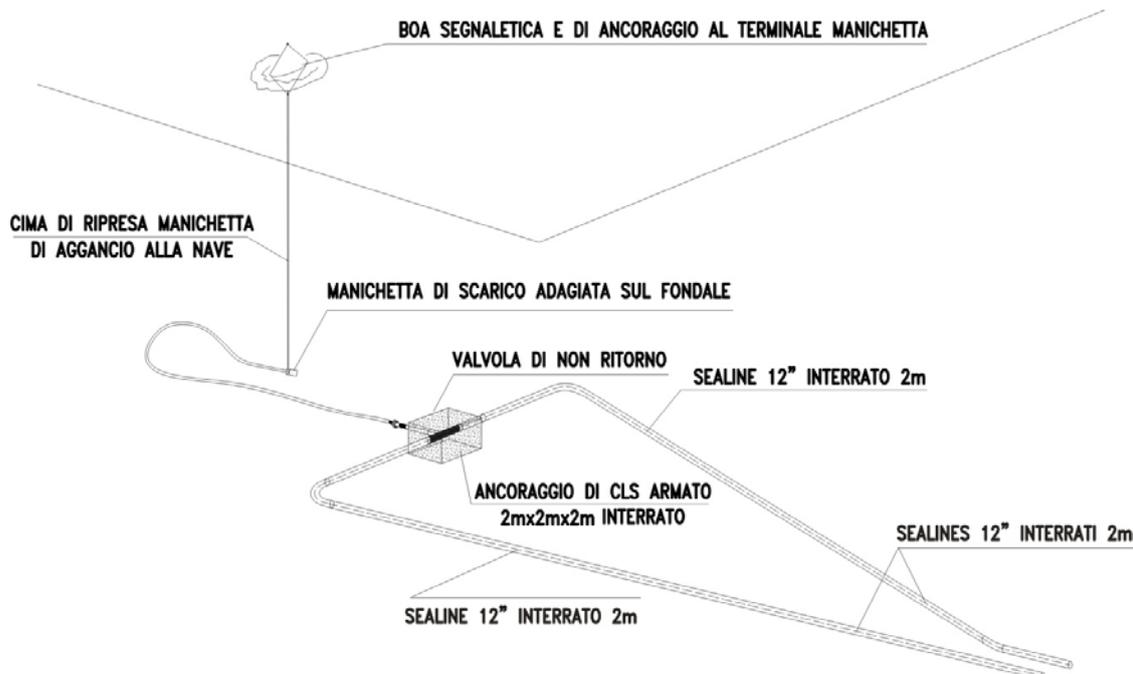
Unione e posizionamento delle sealine nel punto di collegamento con la manichetta
